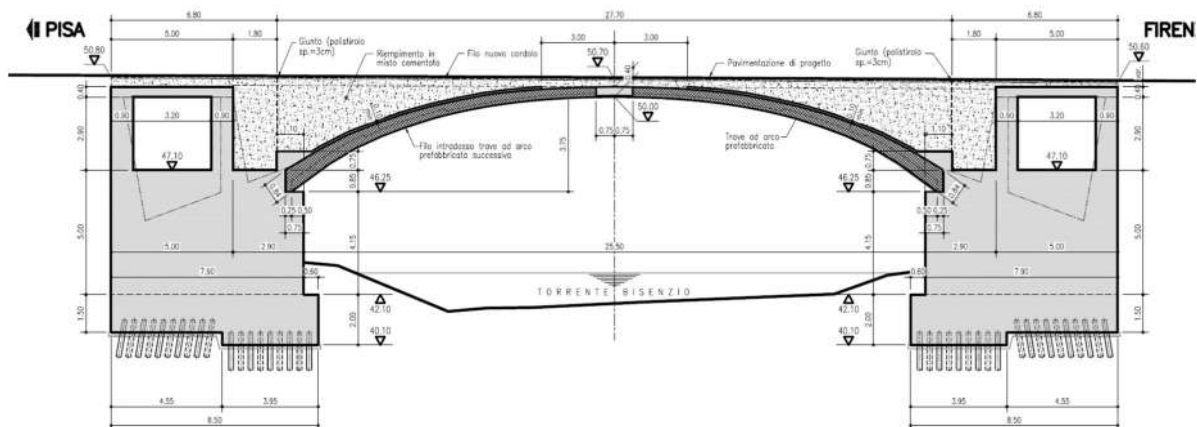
Sezione longitudinale dell'allargamento, lato nord
